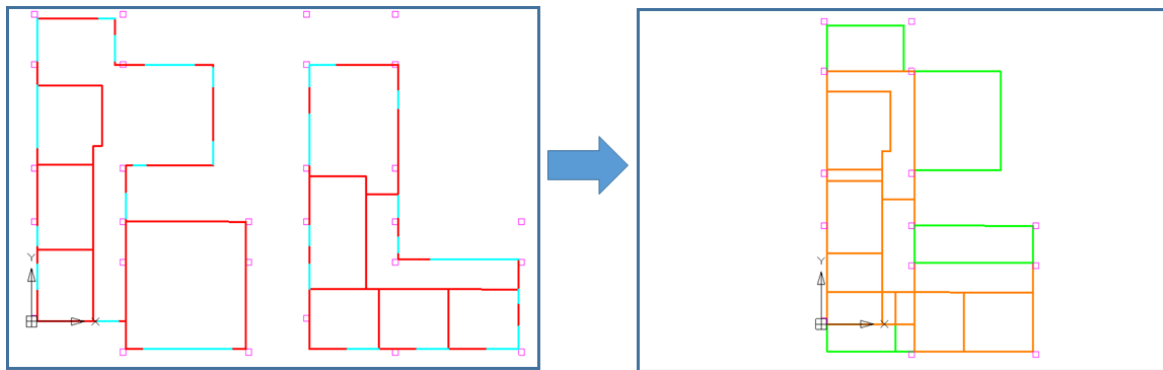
Intersección de polígonos entre plantas para determinar forjados interiores y exteriores.
